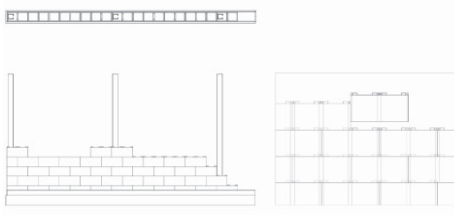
Detalle peto perimetral a la cubierta de chapa metálica. Ronda, Málaga. Fuente: Llanos, Fernando. Creador del sistema Bloqueplas. 2019
